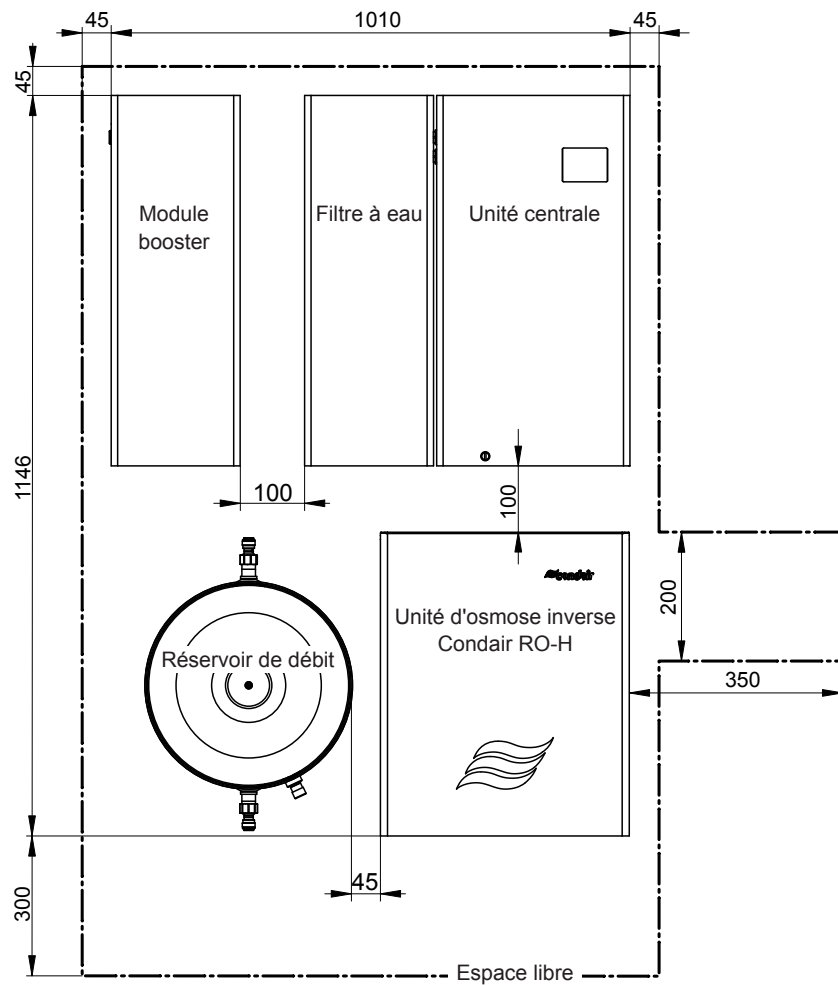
Exemple de placement 3 (dimensions en mm)
